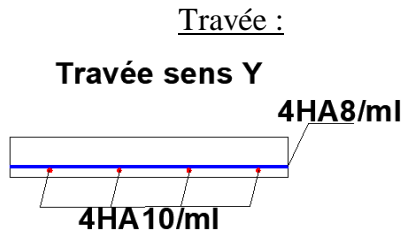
Ferrailage en travée de la DP4 sens Y
